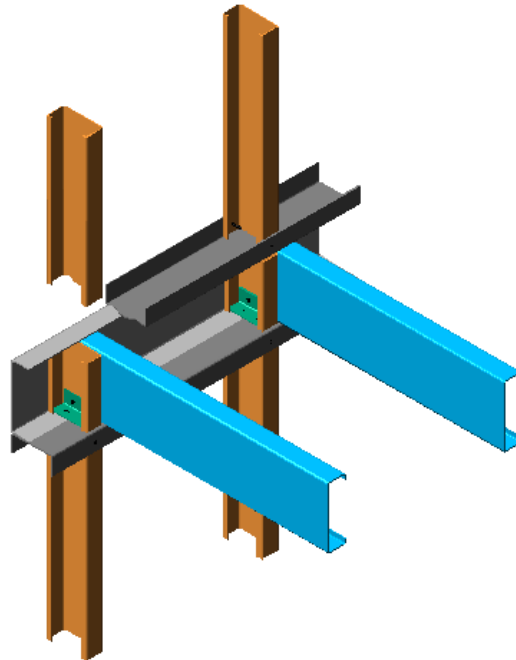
Detalhe do enrijecedor das vigas nos pontos de apoio
